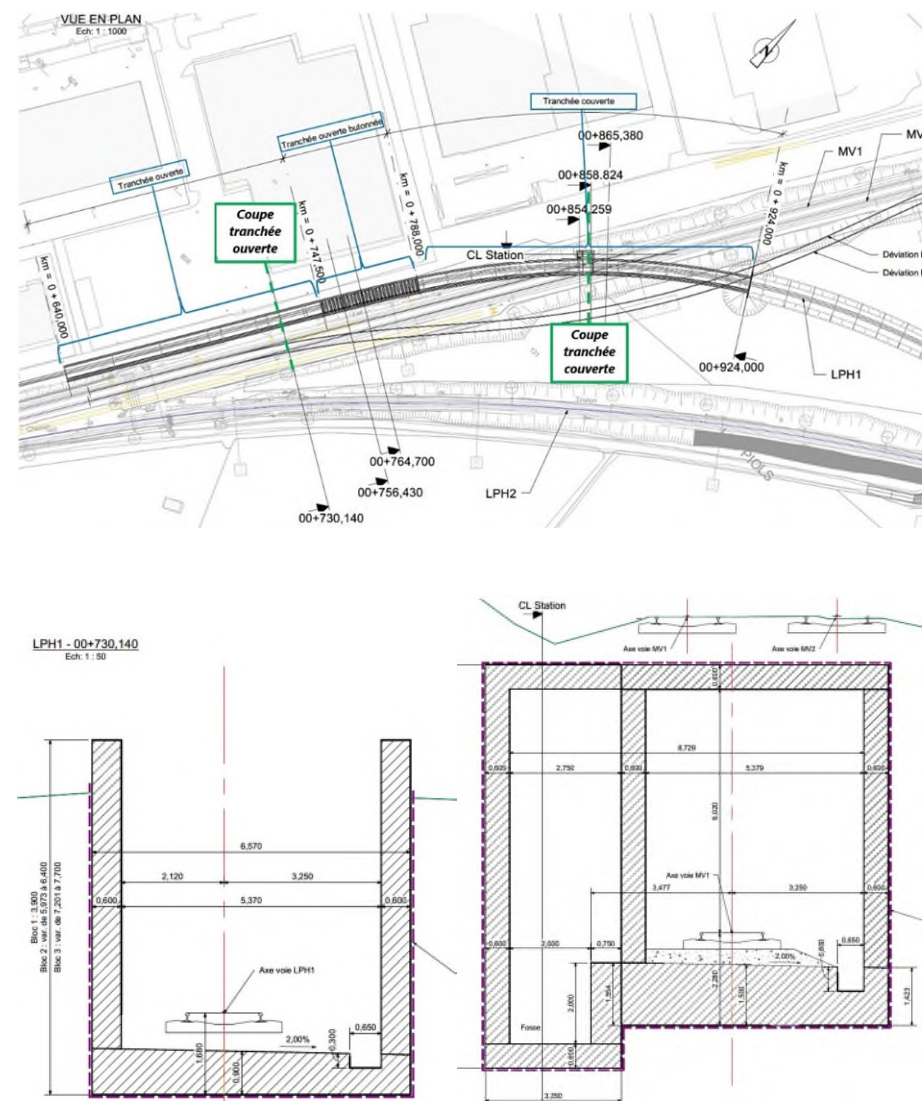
Vue en plan et coupes du terrier (ECTE - 2024)
